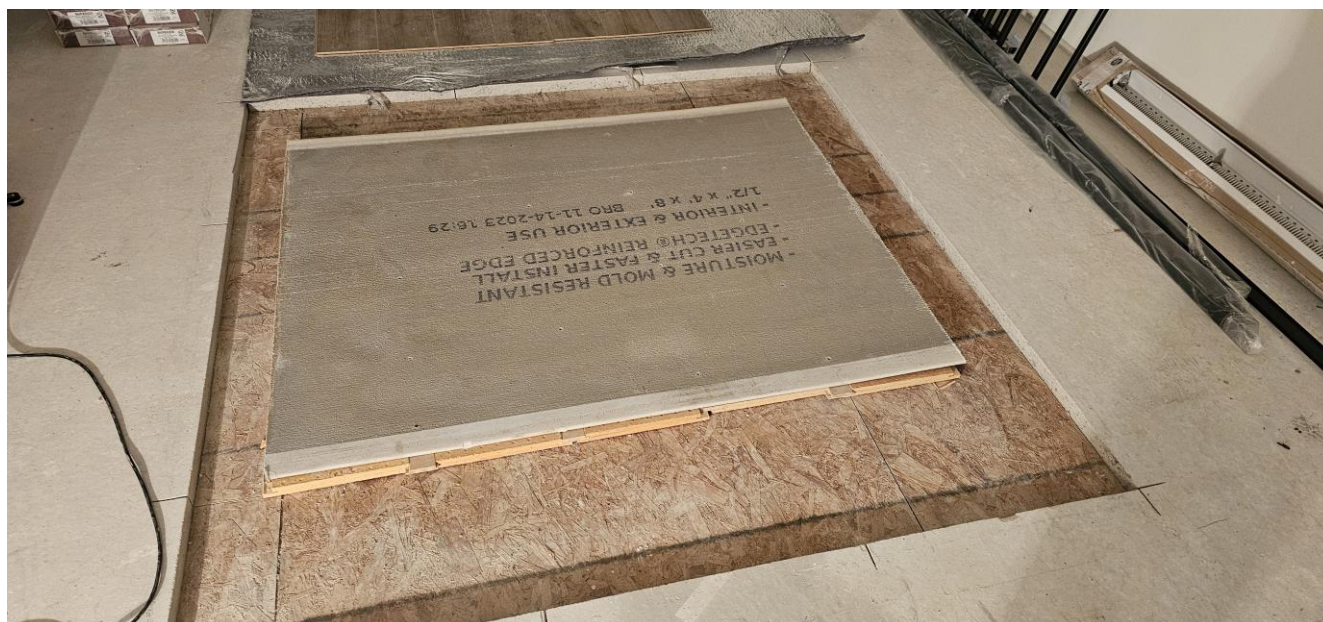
Assemblage Sonomax 25 + Panneau ciment
